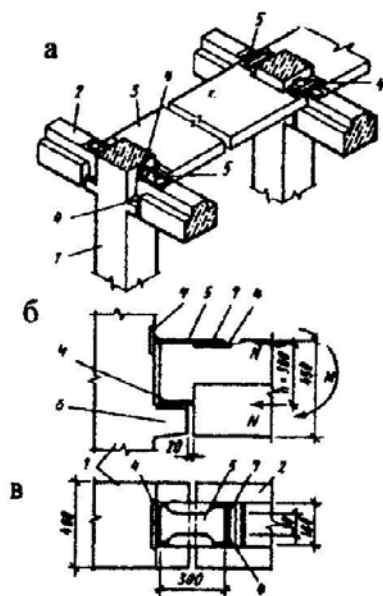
Вузол сполучення ригеля з колоною і багатопустотними плитами перекриттів:
